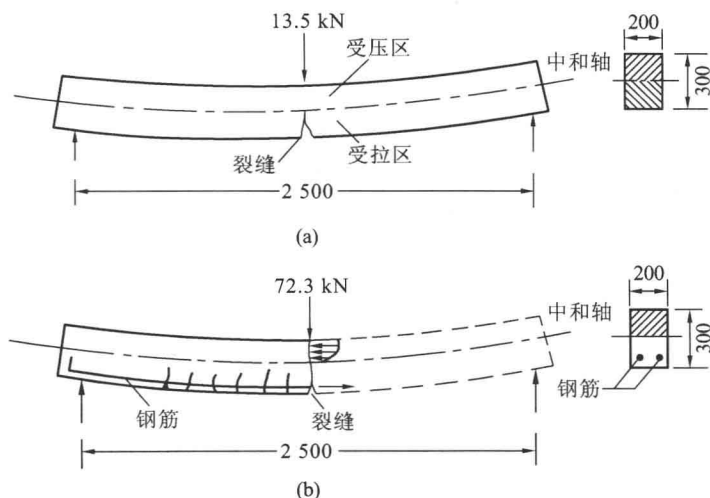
混凝土及钢筋混凝土简支梁的承载力
